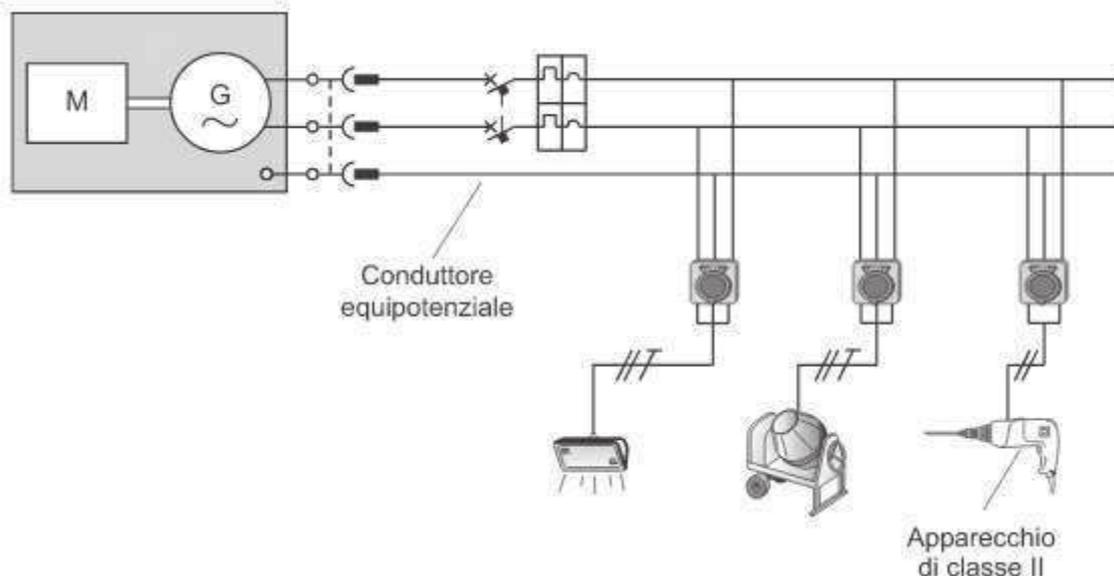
Schema dei collegamenti tra le apparecchiature ed un piccolo gruppo elettrogeno protetto per separazione elettrica (tratto dal volume “Impianti a norme CEI, cantieri edili”, edizione Tuttonormel, Torino)
